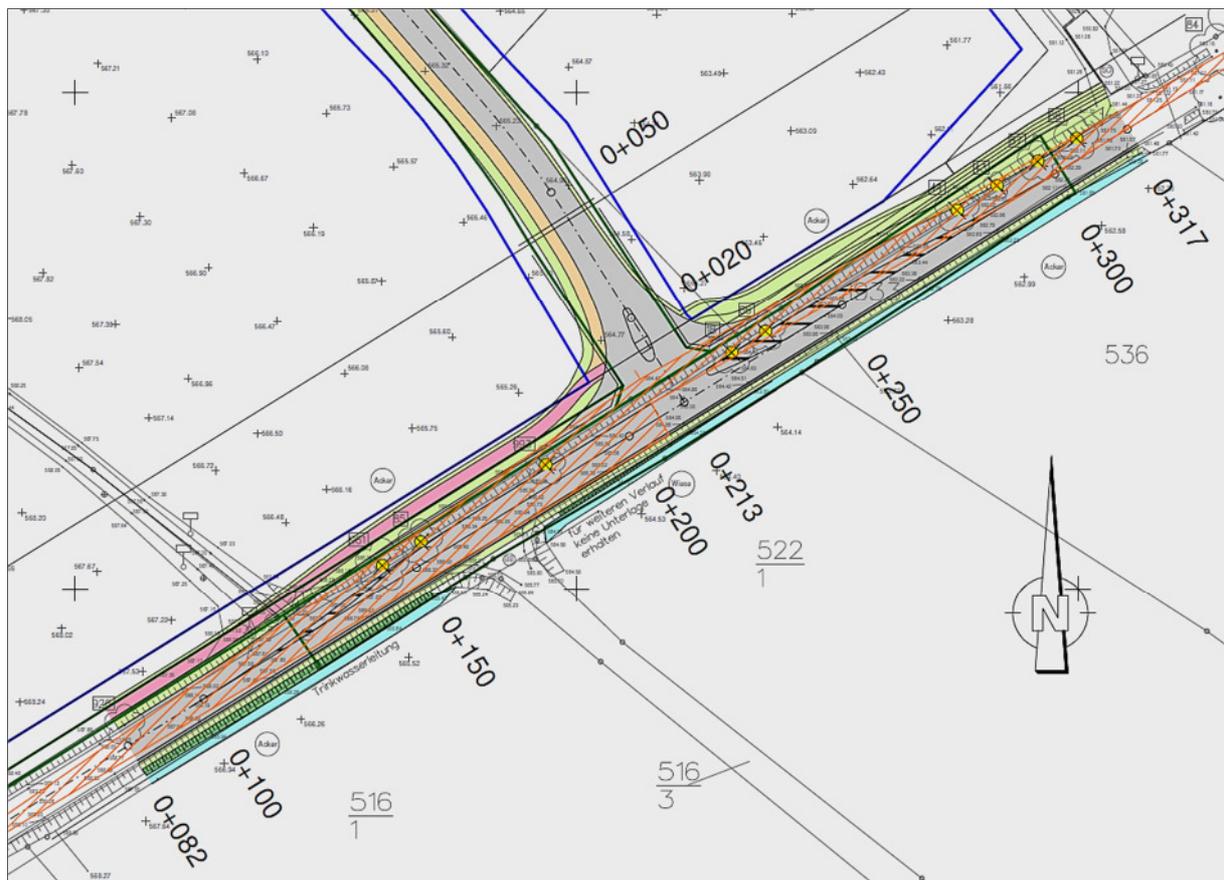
Vorplanung Einmündung Planstraße A in B 101
